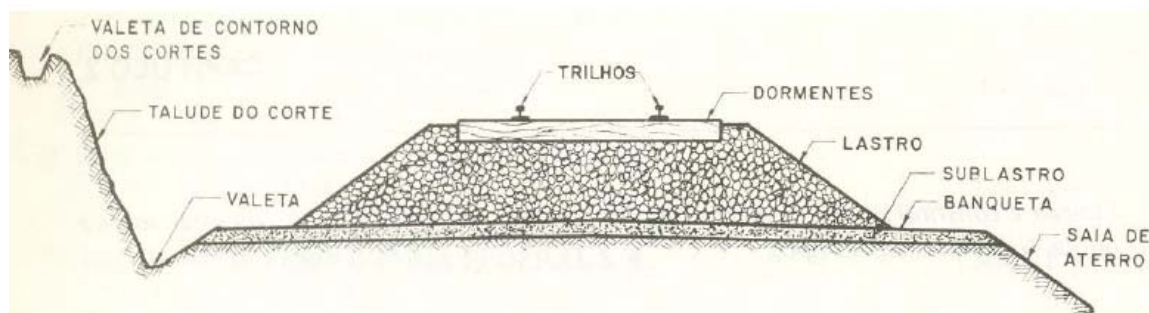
Superestrutura ferroviária. (Fonte: Souza, 2008).
